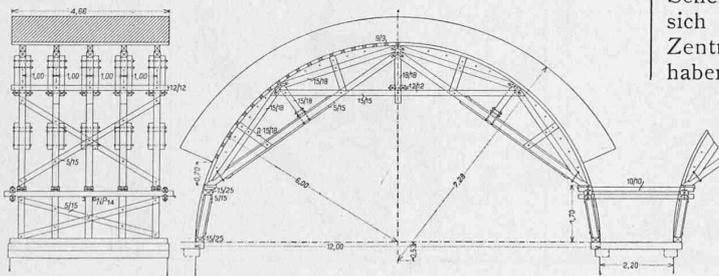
Lehrgerüst der 12 m Öffnungen. — Masstab 1:200.
